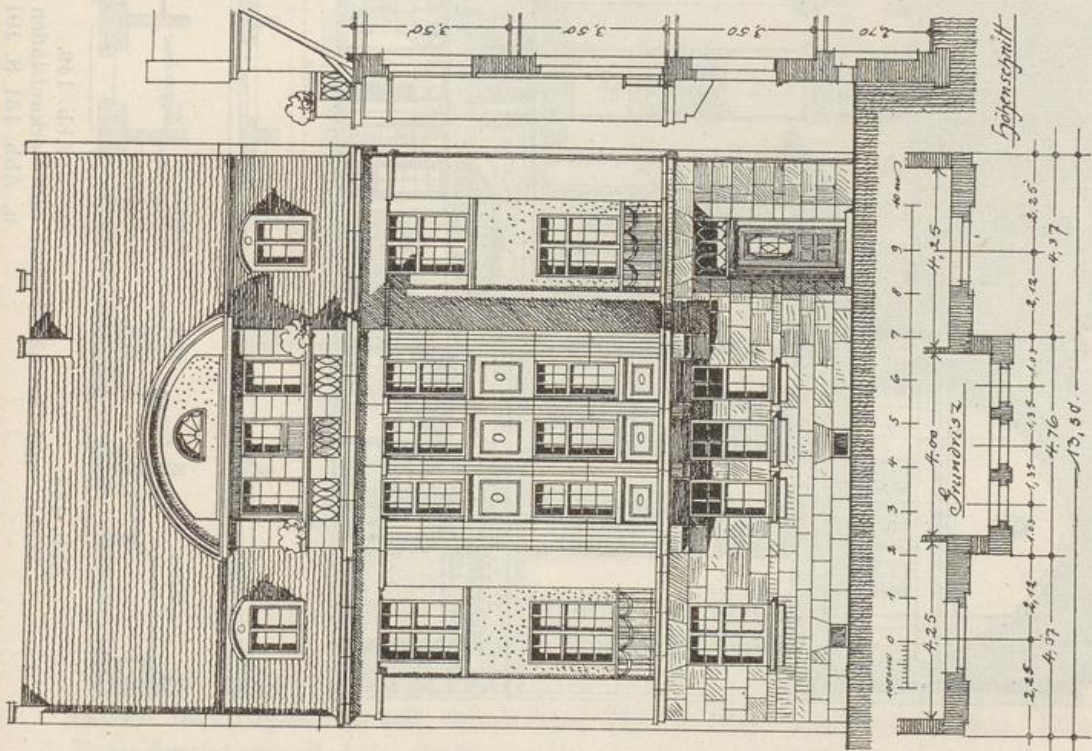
Wohnhaus zu Grundriß Abb. 118 S. 81 in etwas
